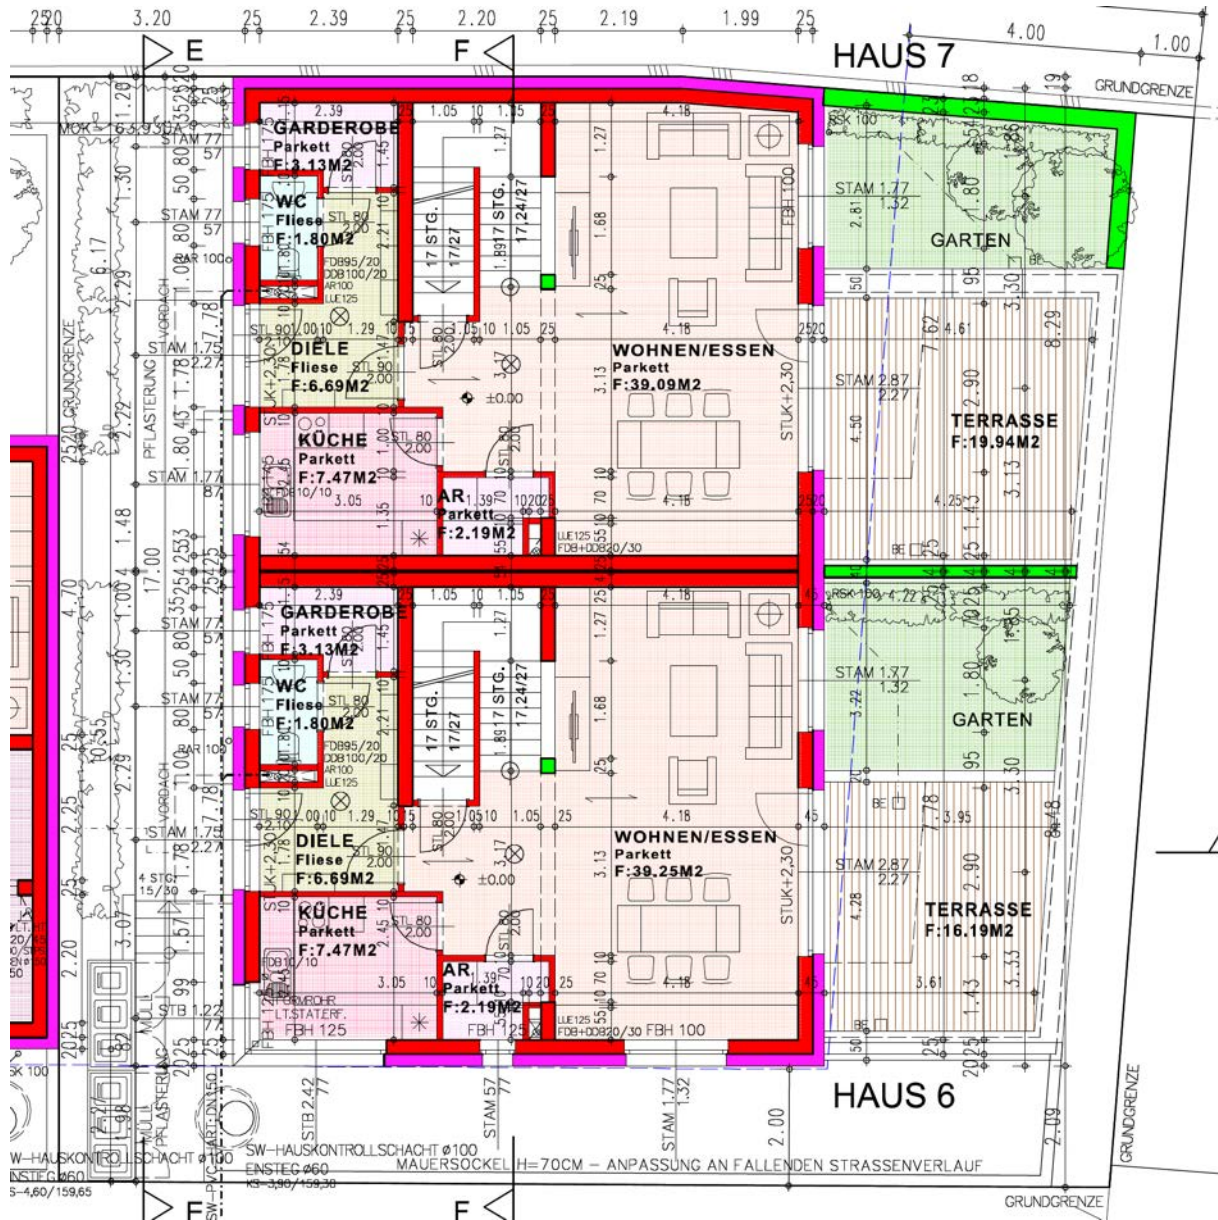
Einreichplan – Erdgeschoss Haus 6+7 / Quelle: auftraggebende Partei
